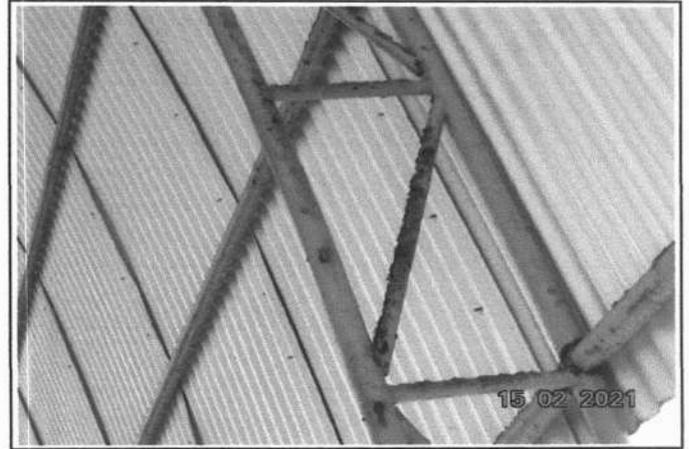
RECUPERAÇÃO, TRATAMENTO E PINTURA DE ESTRUTURAS METÁLICAS
